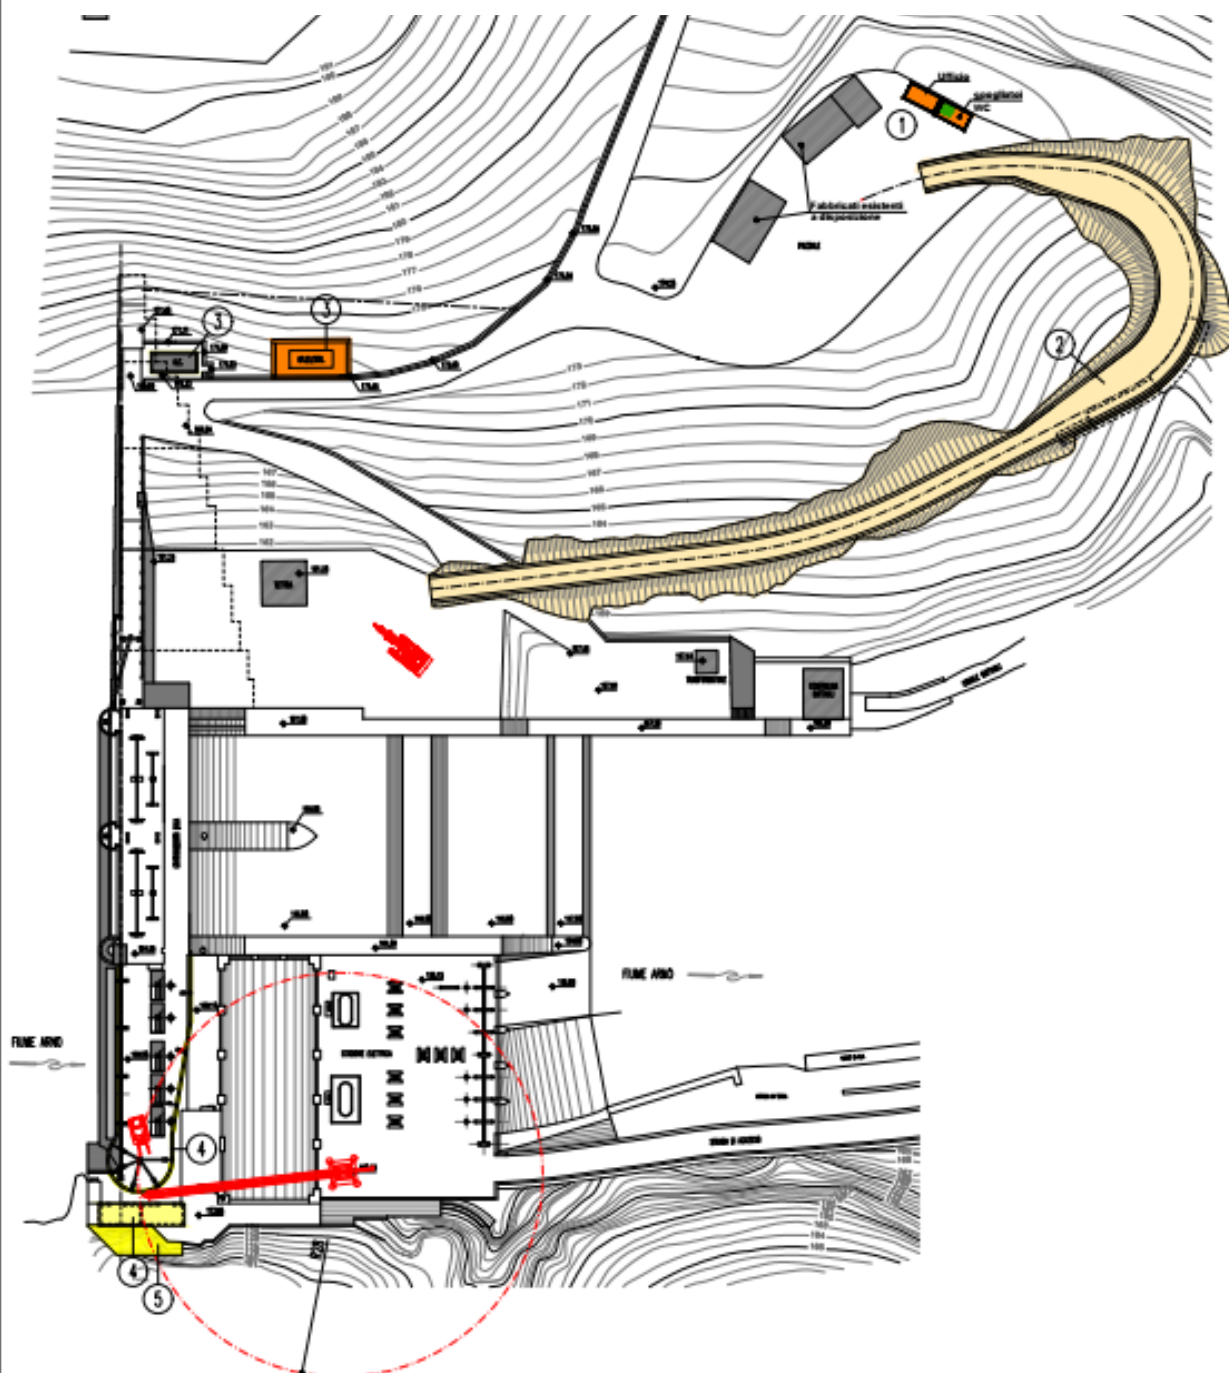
1 – Estratto planimetrico elaborato progettuale – Cantierizzazione FASE1
